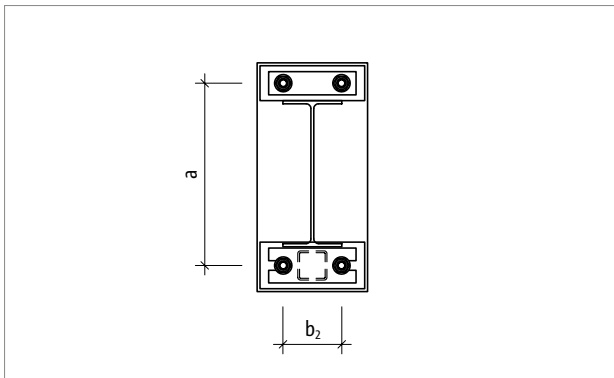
Plaque frontale saillante T type S : calcul des entrées géométriques ; vue globale
